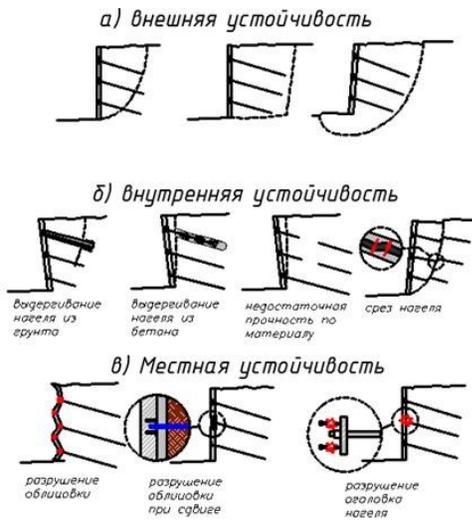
Основные причины разрушения грунтовой нагельной системы.
